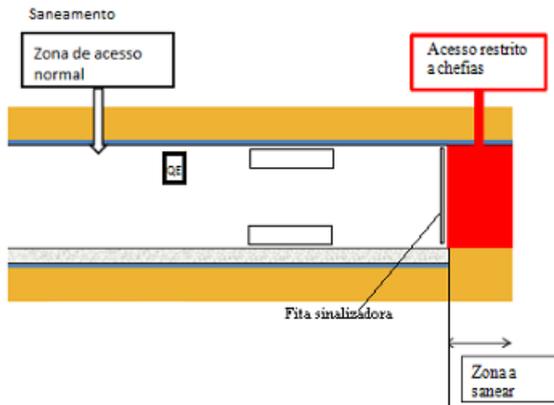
Zona de restrição em frentes de escavação (fonte: autores)
